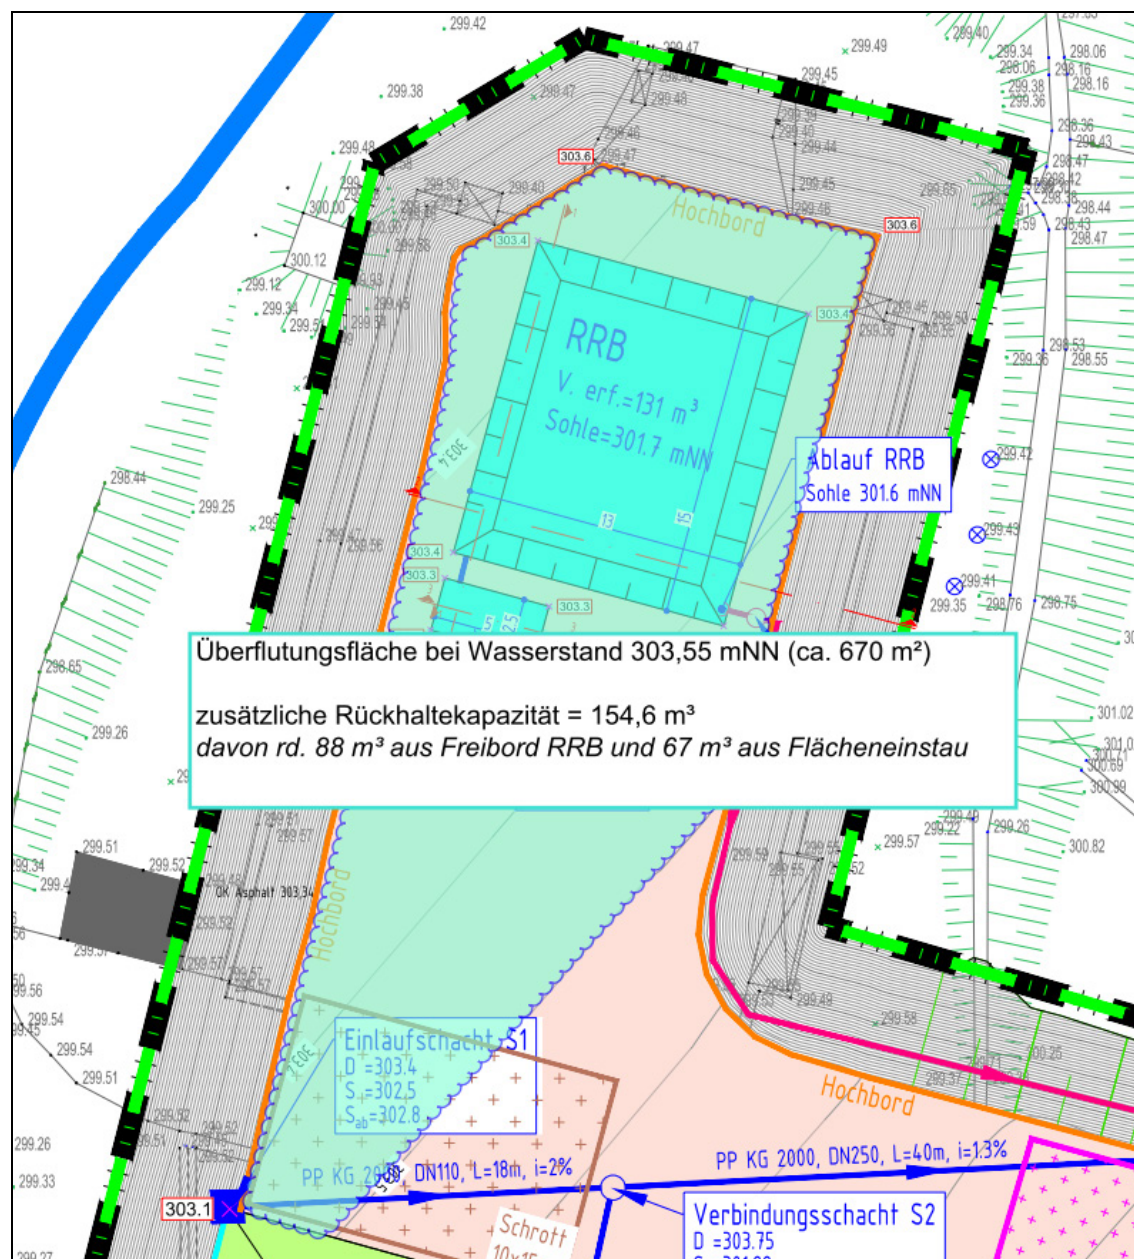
Darstellung der Überflutungsfläche, Planausschnitt Plan Nr. 204
